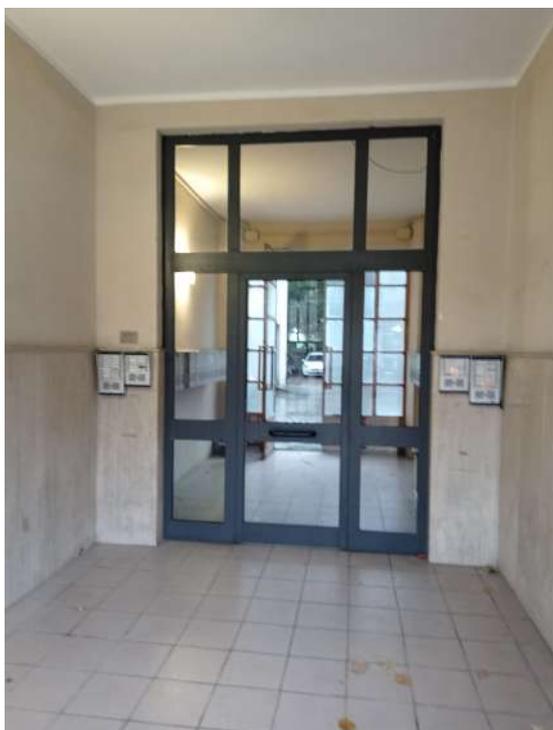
prospetto interno del fabbricato dal cortile.
